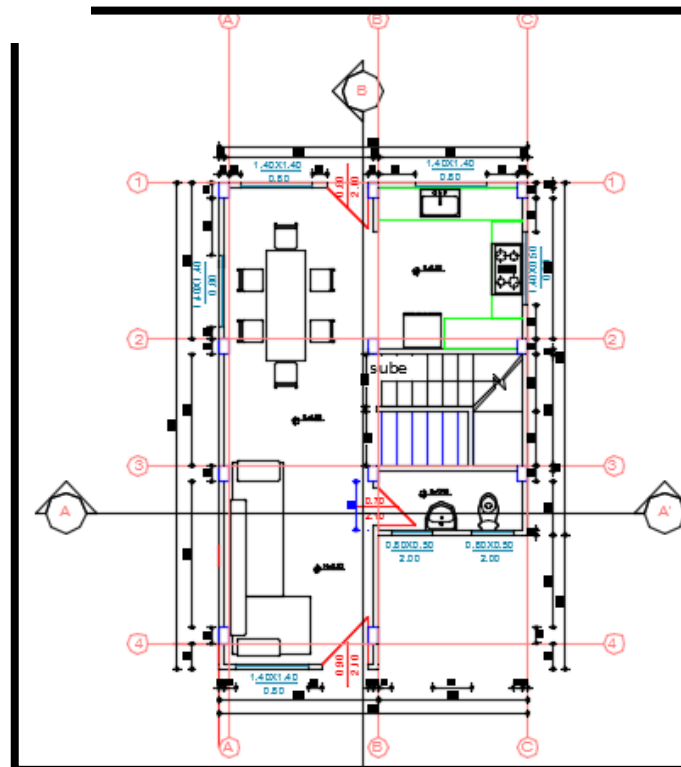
Prototipo 2, Plano arquitectónico p. baja.
